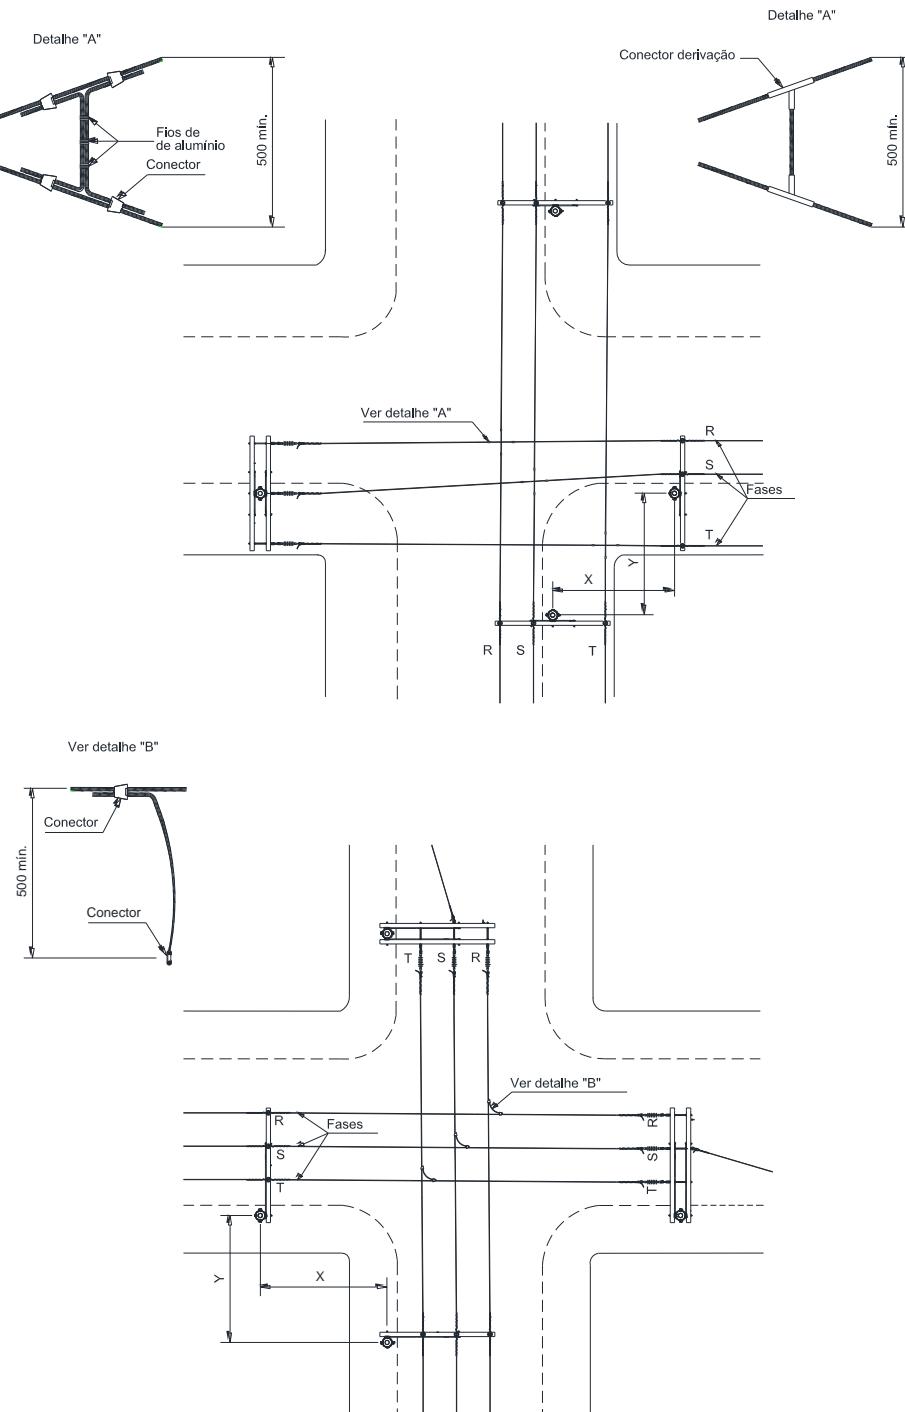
Amarrações e ligações – Estrutura primária – Cruzamento aéreo
